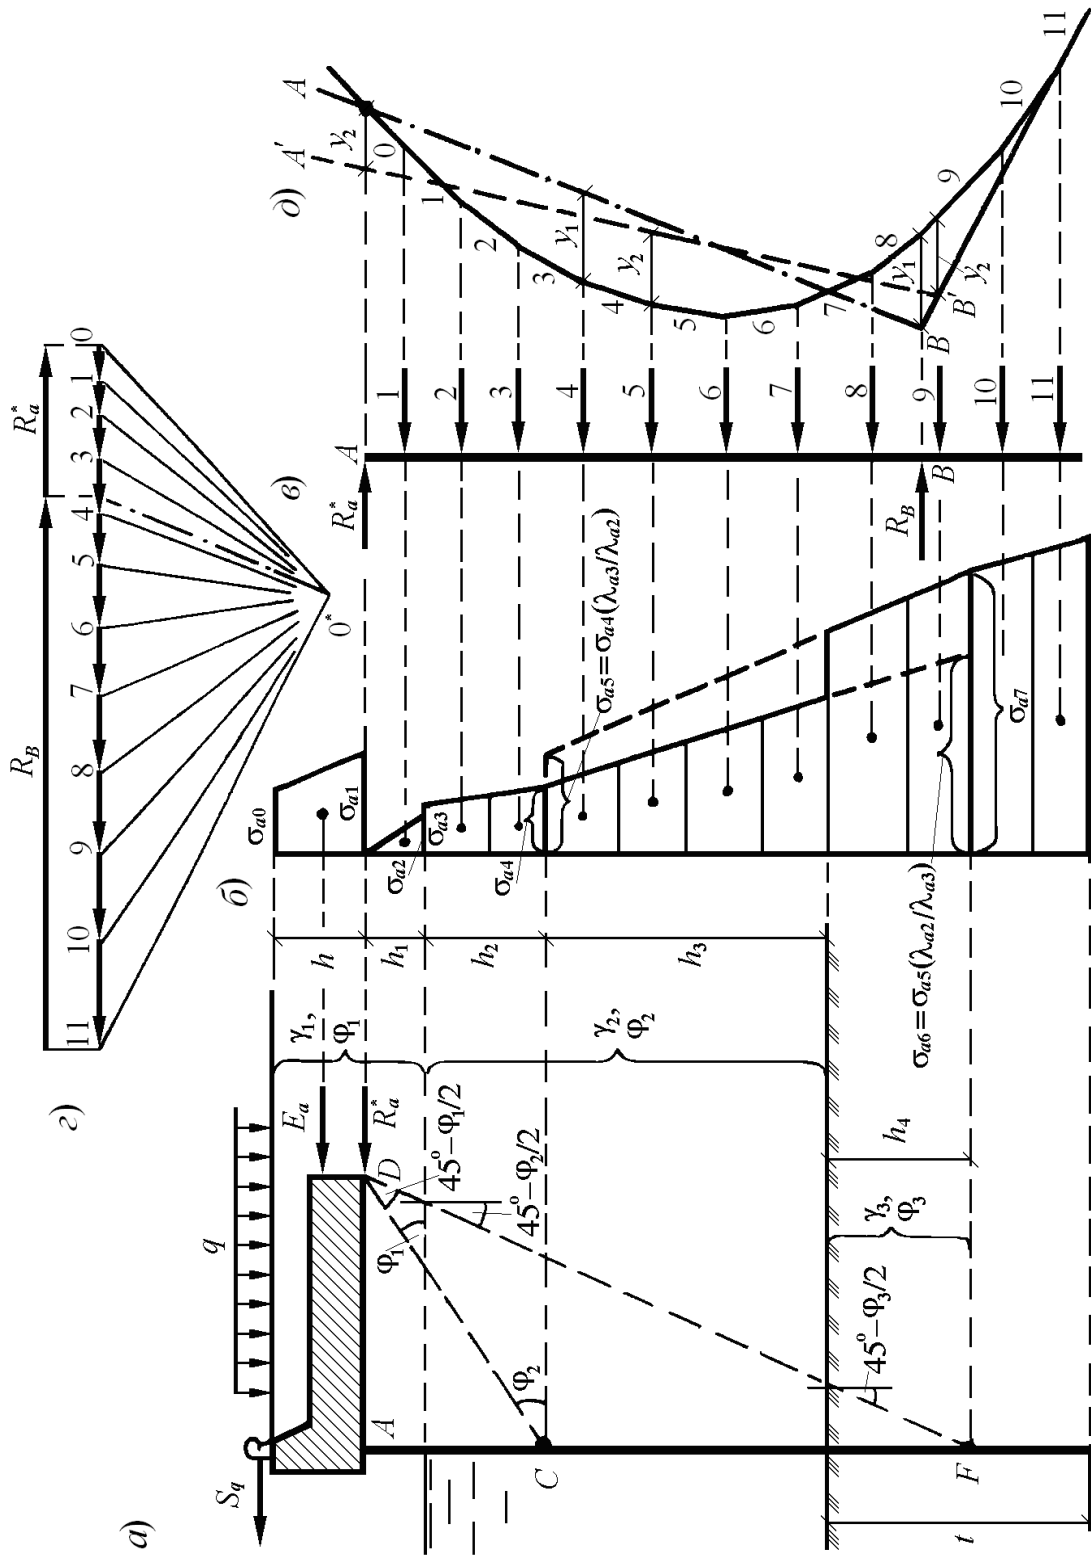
Расчет полной горизонтальной нагрузки на ростверк с передней шпунтовой стенкой от давления грунта
